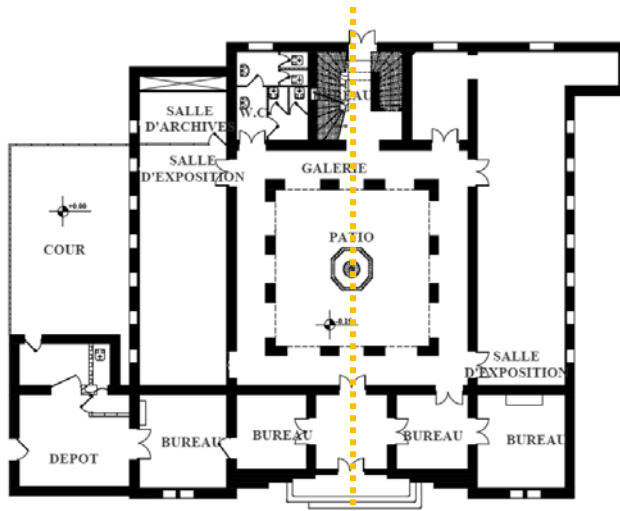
Plan du rez-de-chaussée de la Médersa (Source\_2015 : BET BELBACHIR).
